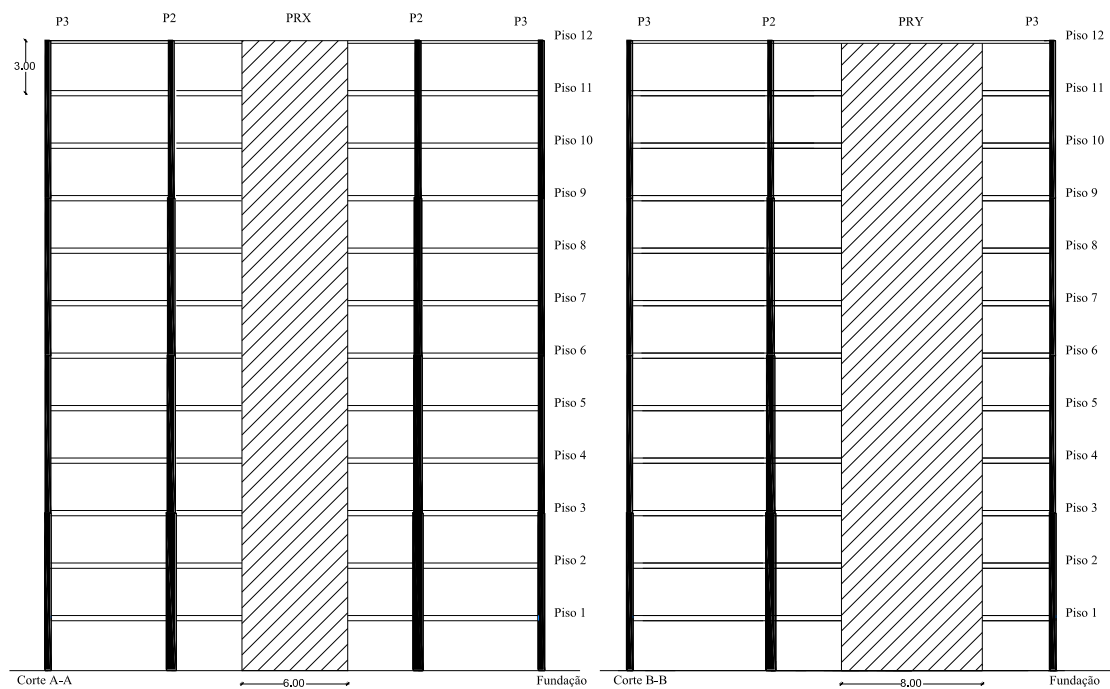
Fachada do edifício: Corte A-A - Direção X; Corte B-B - Direção Y
